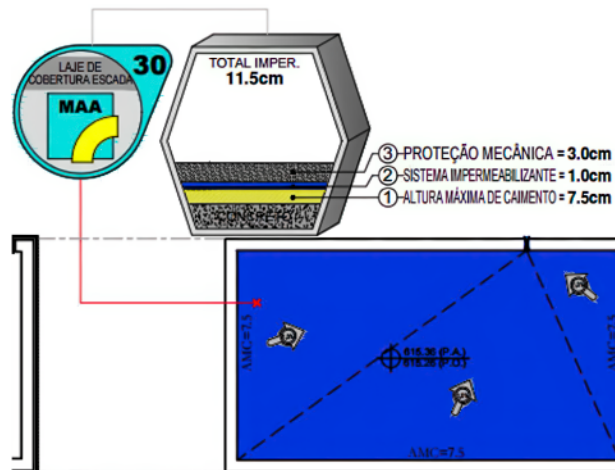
Fonte: Obra Seca Projeto e Consultoria em Impermeabilização
